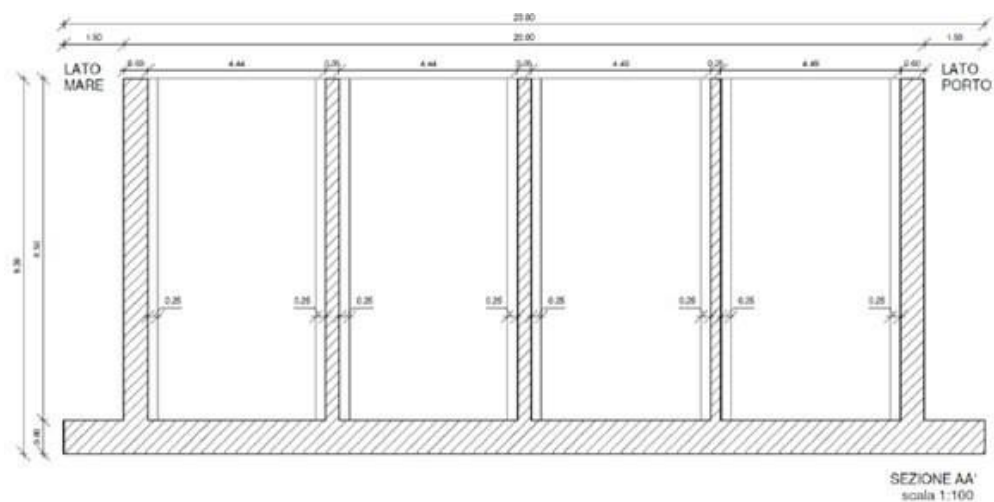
Cassone tipo A: carpenteria – Sezione verticale A-A
